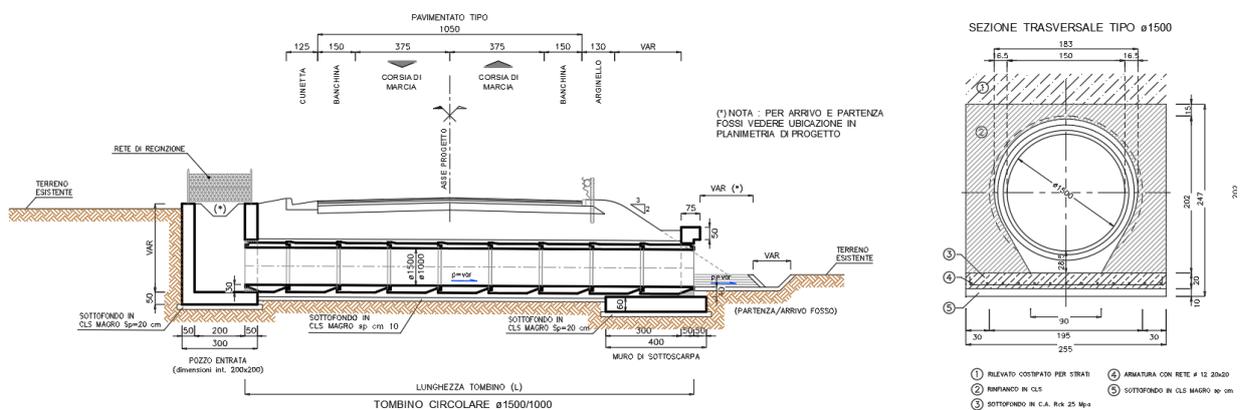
Tombino circolare (sezione longitudinale e prospetto)
